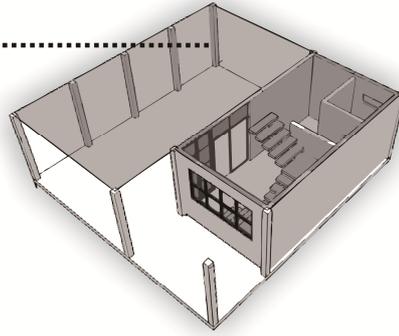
Rekomendasi desain bangunan baru dengan pendekatan matching dengan bangunan eksisting
